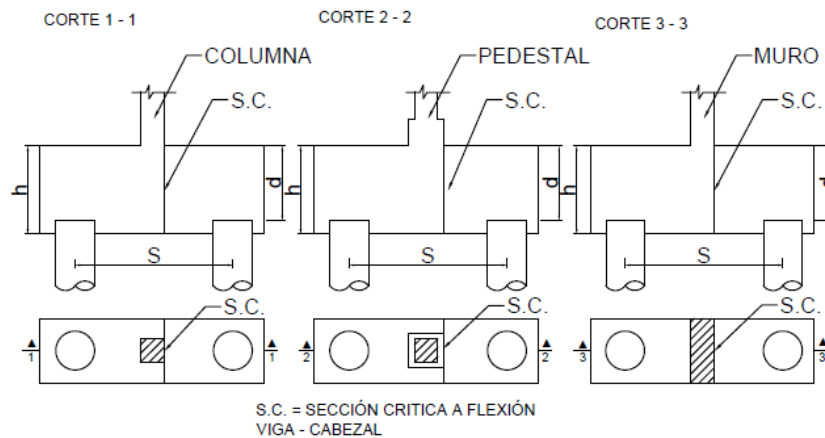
Momento flector en la columna, pedestal o muro de concreto.
